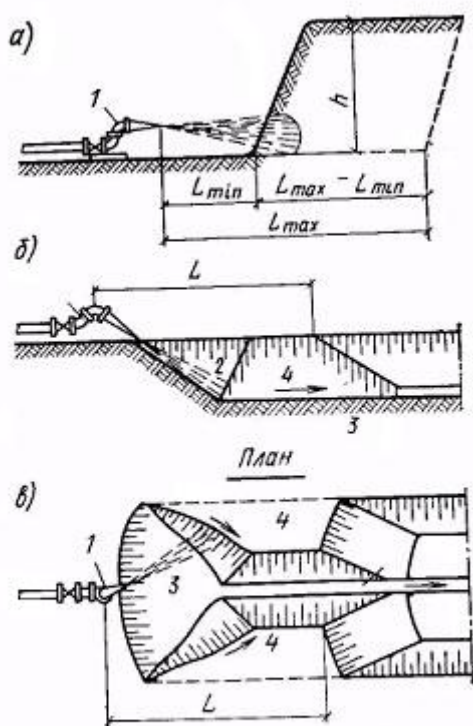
Способы размыва грунта гидромонитором: а — встречным забоем (снизу вверх); б, в — попутным забоем (сверху вниз); 1 — гидромонитор; 2 — канава для отвода, пульпы; 3, 4 — последовательность разработки забоя.
